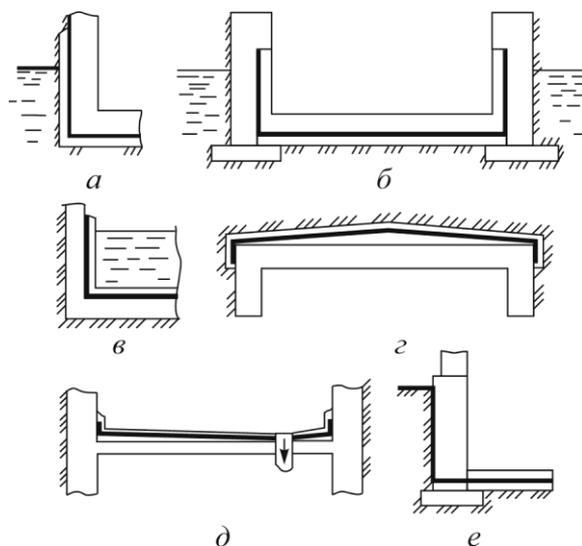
Типы гидроизоляции: *a* – наружная противонапорная изоляции; *б* – внутренняя напорная гидроизоляция; *в* – гидроизоляция водосборников; *г* – гидроизоляция крышевидной формы для защиты от поверхностных или фильтрационных вод; *д* – гидроизоляция лотковой формы внутренних помещений; *е* – гидроизоляция для защиты от капиллярной влаги
